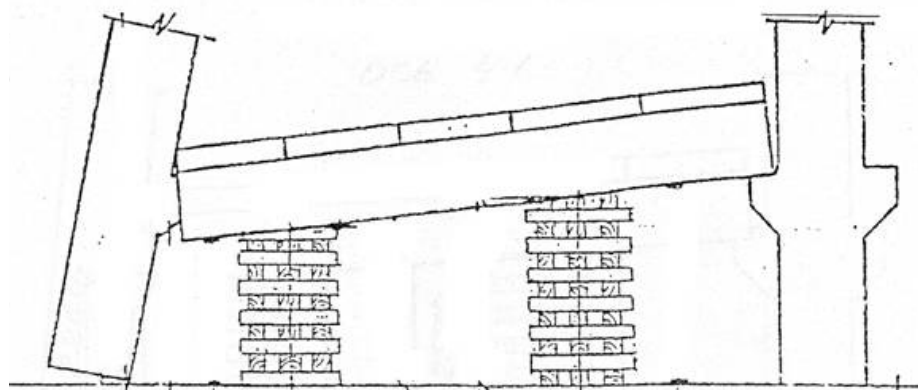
Схема усиления конструкций перекрытия над помещением 805/3.
